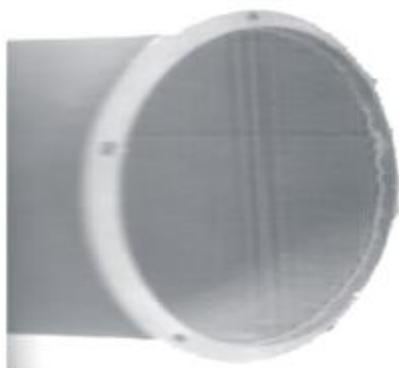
Фланец, насаженный на круглый воздуховод
